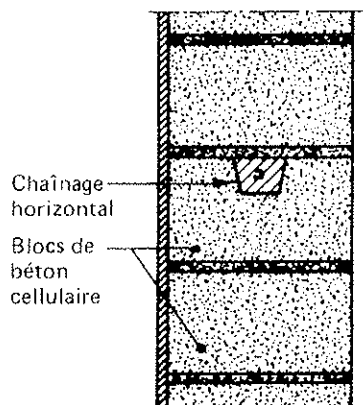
Coupe horizontale sur un contrefort au niveau d'un chaînage horizontal
